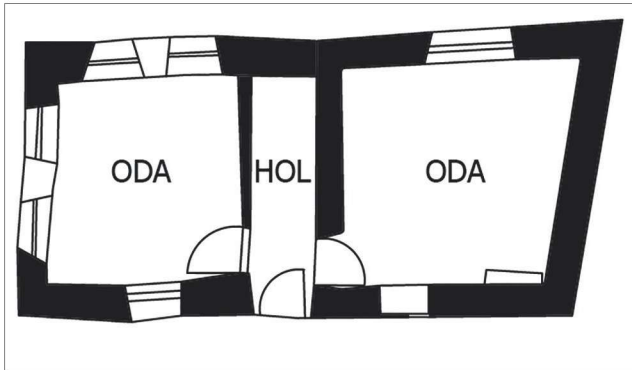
944 Parsel, 1. Kat Planı / Building lot: 944(registered), first floor plan
